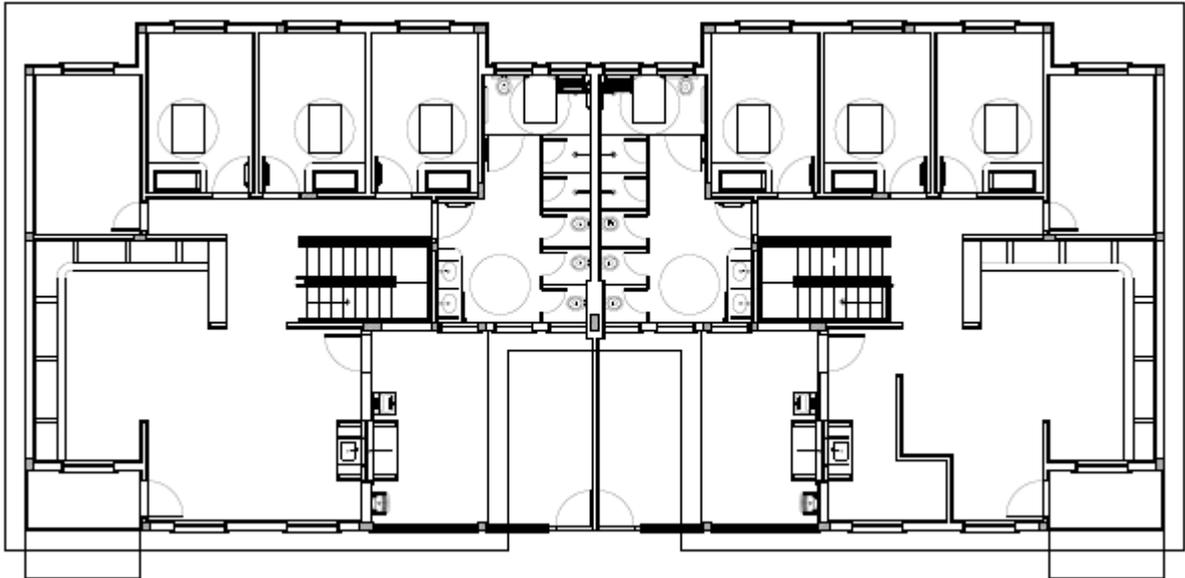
Layout interno das edificações tipo 1 – Subsolo – Escala 1:200
